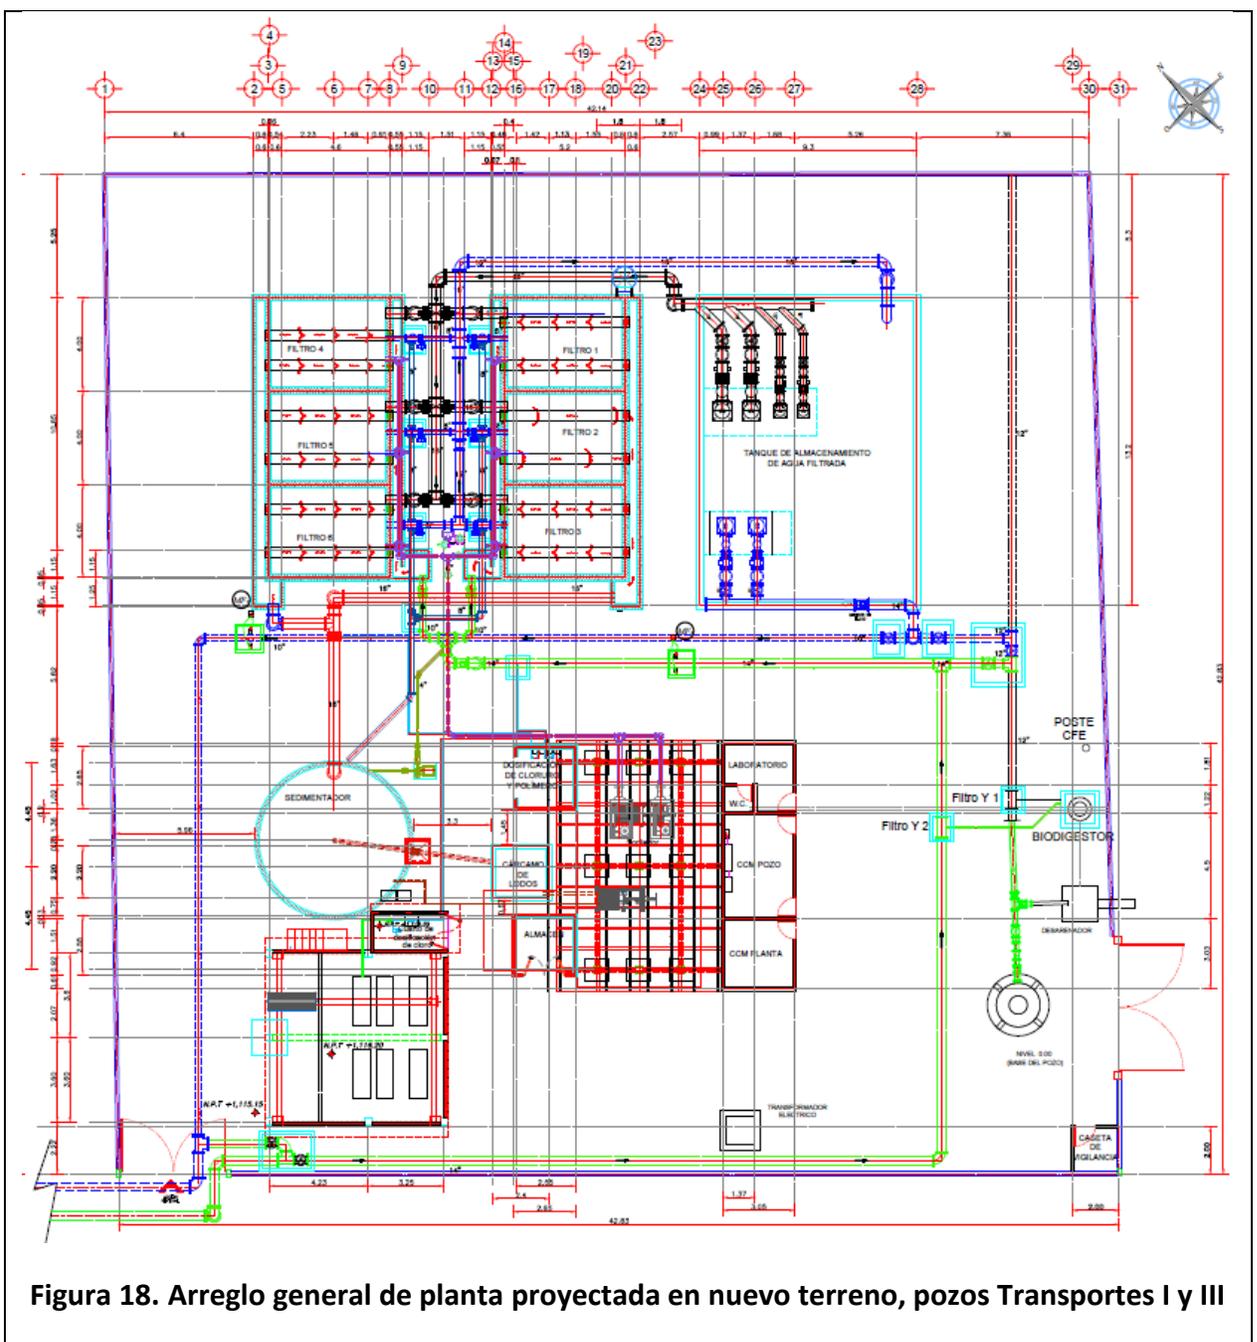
Arreglo general de planta proyectada en nuevo terreno, pozos Transportes I y III
